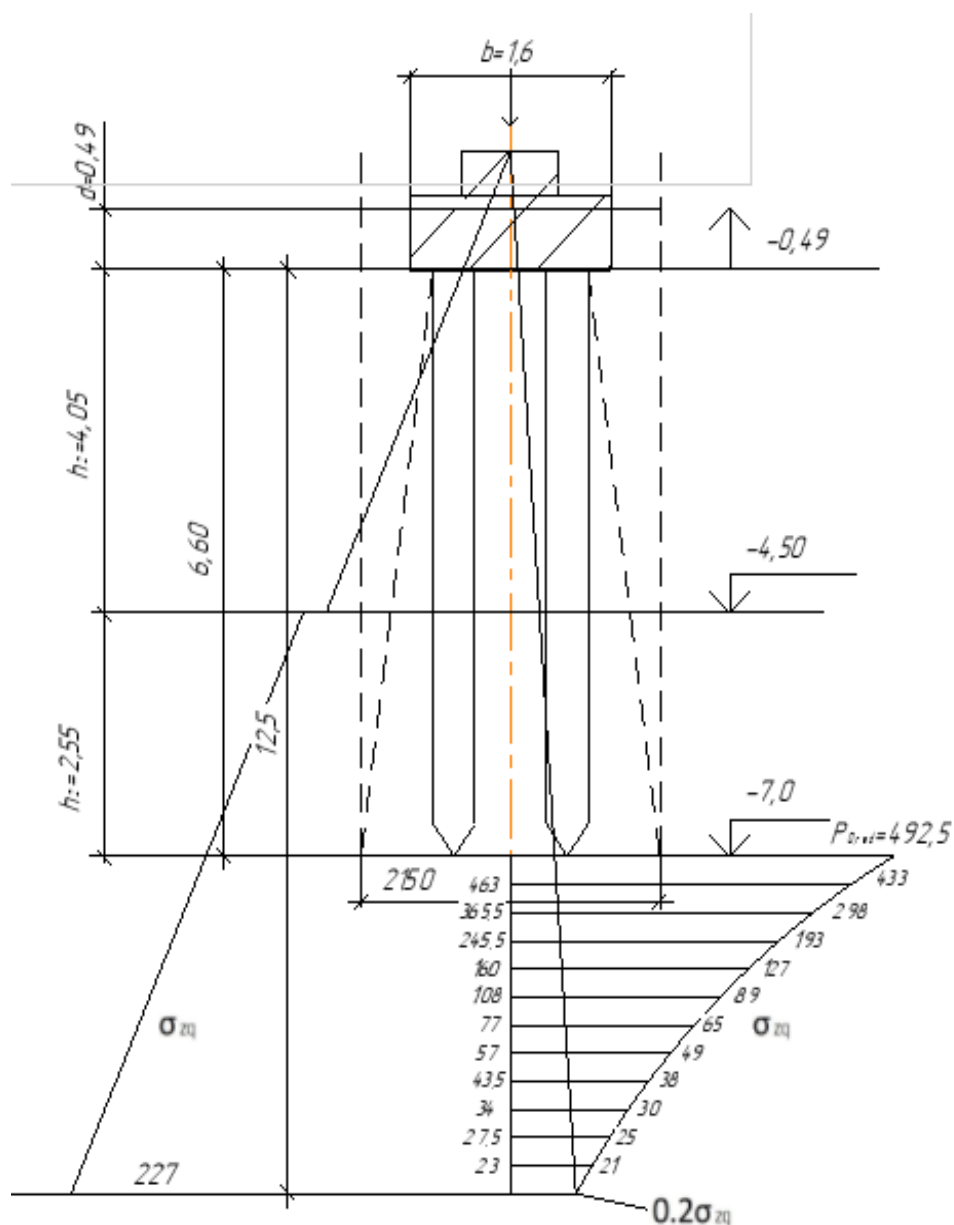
Расчетная схема осадки свайного фундамента
